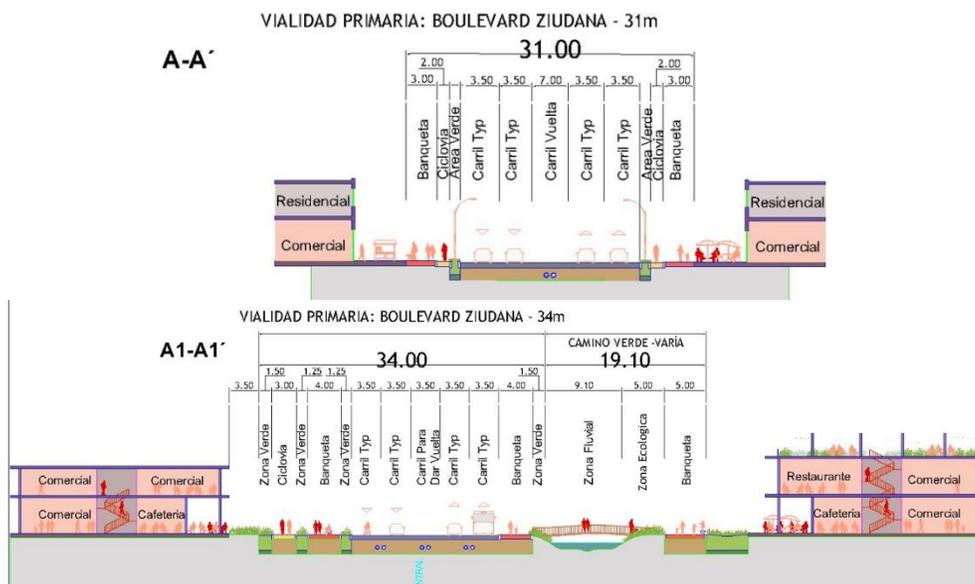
Sección vial principal (Norte 3). Fuente Plan Maestro de Urbanización “Ziudana” aprobado por cabildo.
